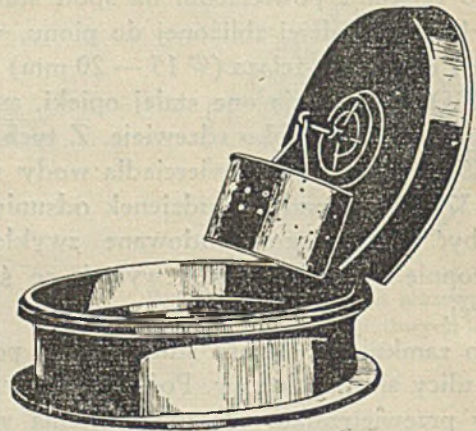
Pokrywa z wiekiem wypełnionym twardym drzewem.
